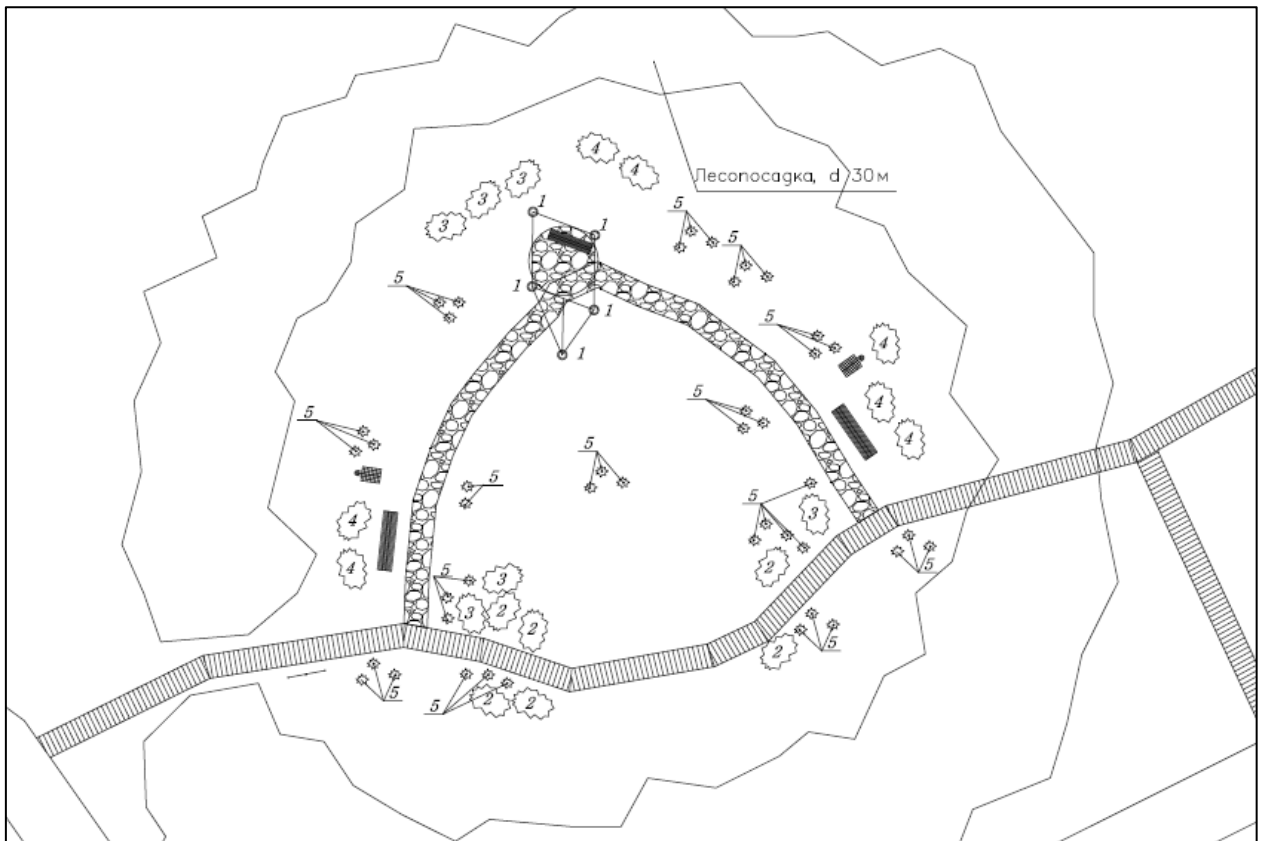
Фрагмент генплана 16, схема посадки растений для зоны тихого отдыха
